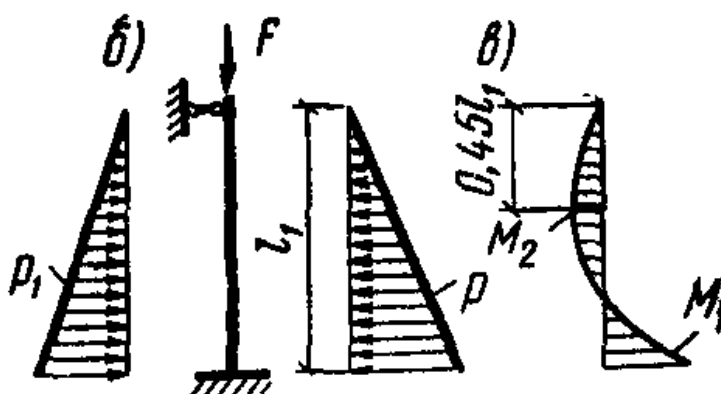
К расчету стены прямоугольного резервуара, работающей по балочной схеме
